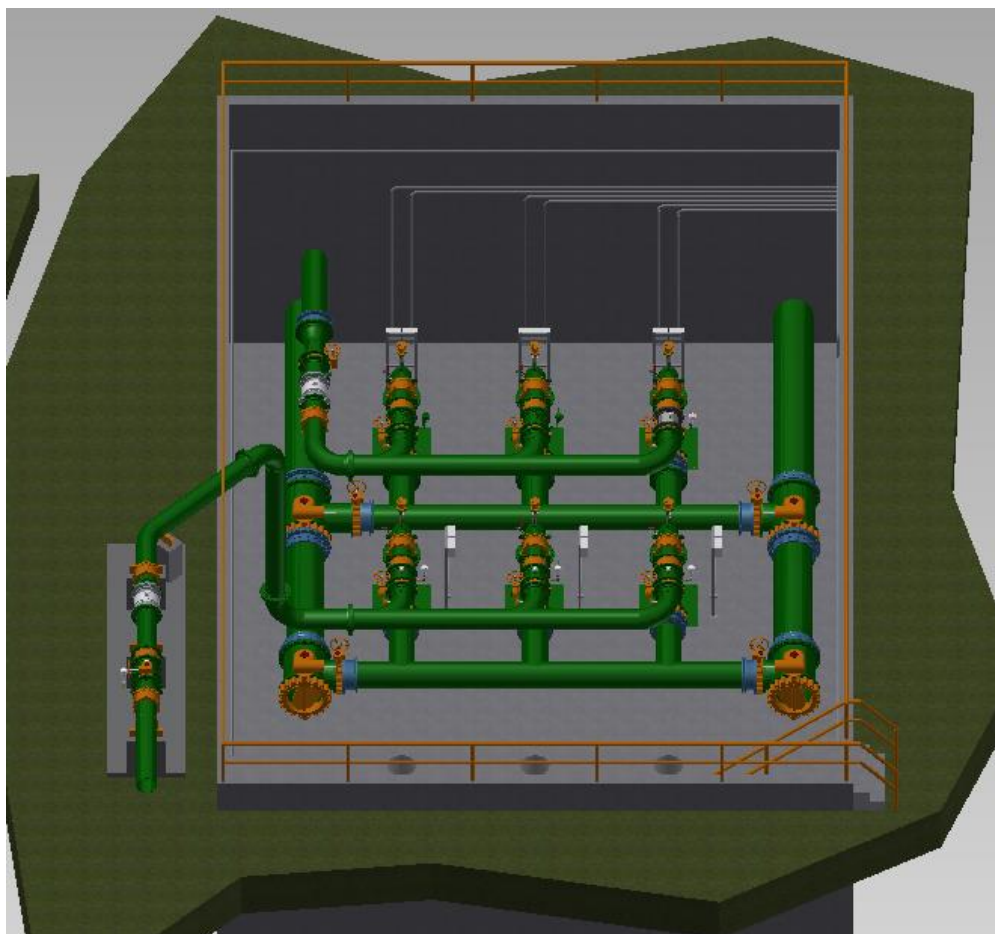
Vista frontal elevada de la instalación de bombeo en la PPAP.
